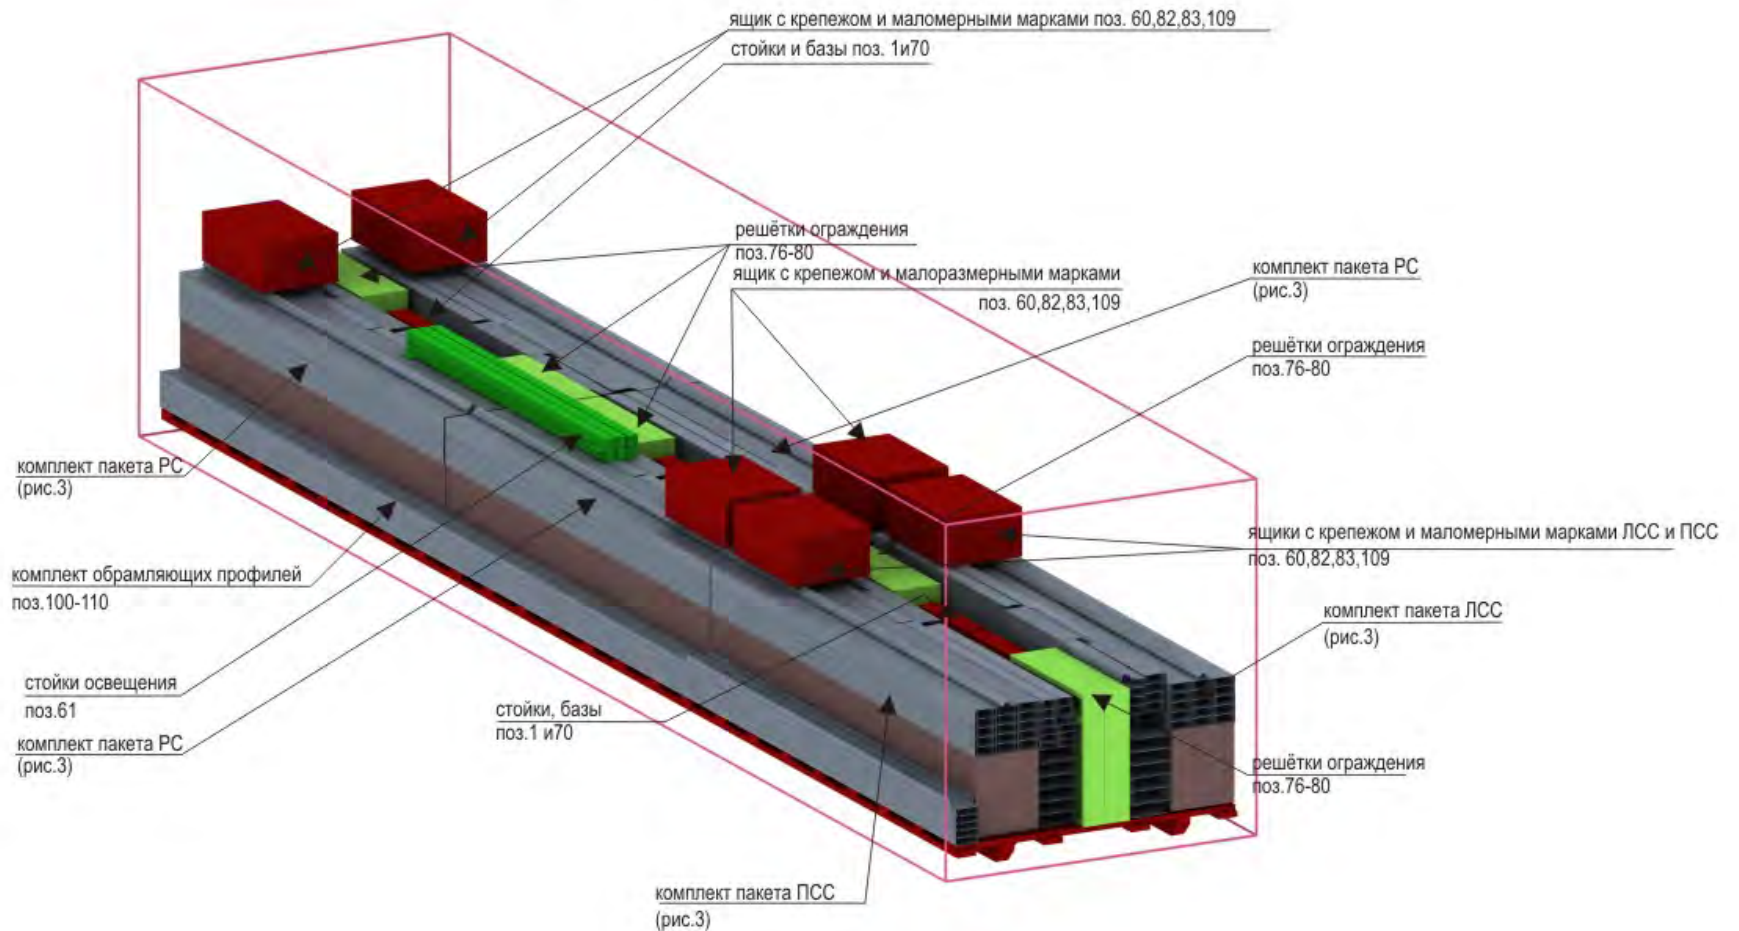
Схема упаковки на паллет конструкций платформы ПУМА 264-4-1.1-ДПК. Контейнер № 2
